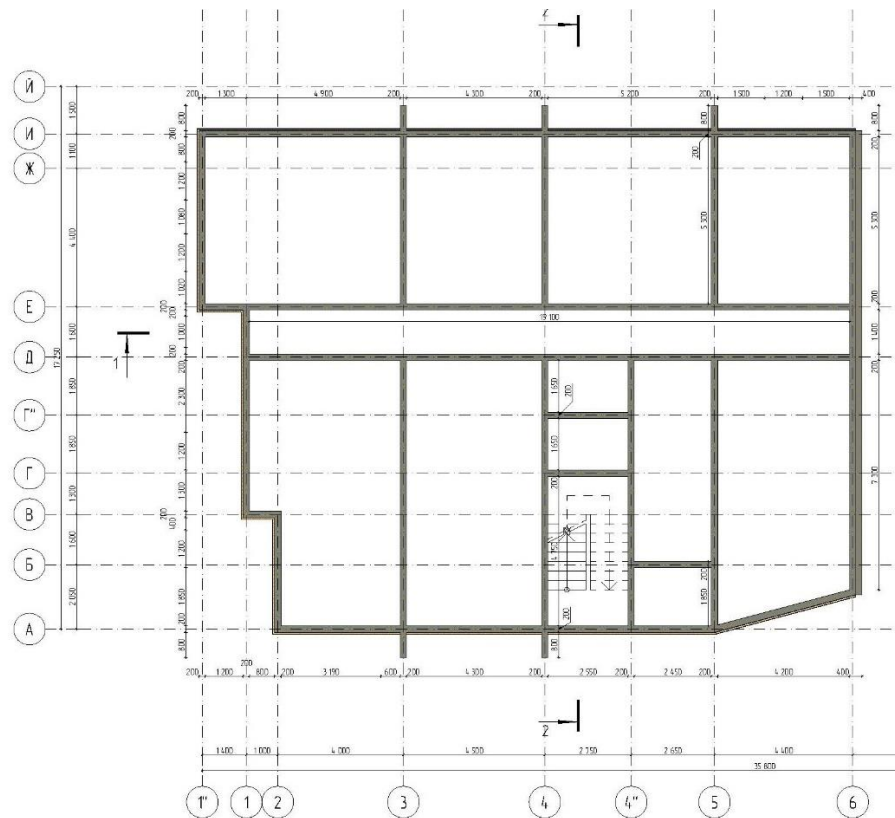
План фундаментных стен на отметке – 12.220
